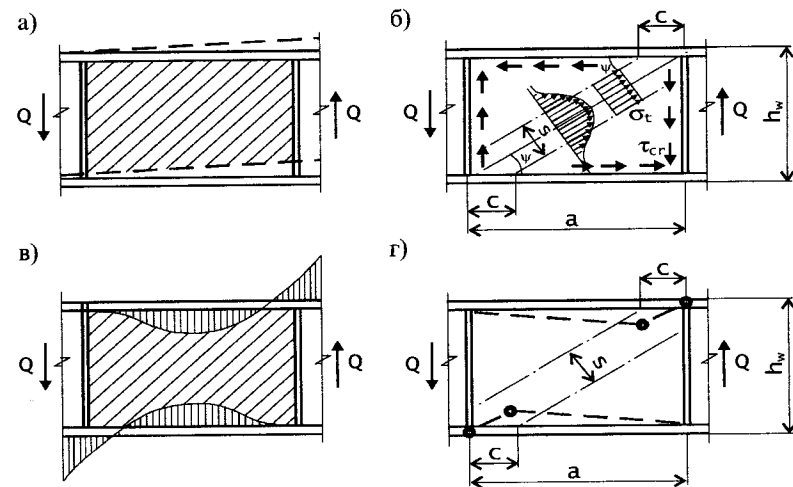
К расчету тонкостенных двутавровых балок на поперечную силу
